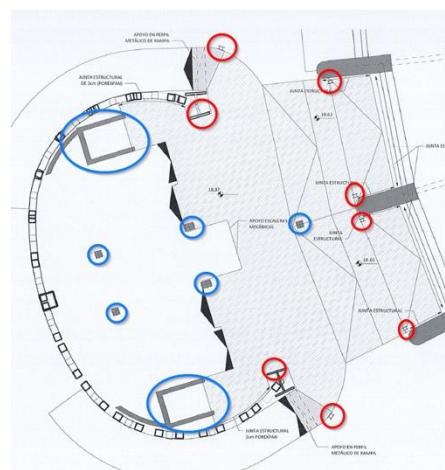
Planta tipo. Apoyos en elementos verticales de hormigón y metálicos.
